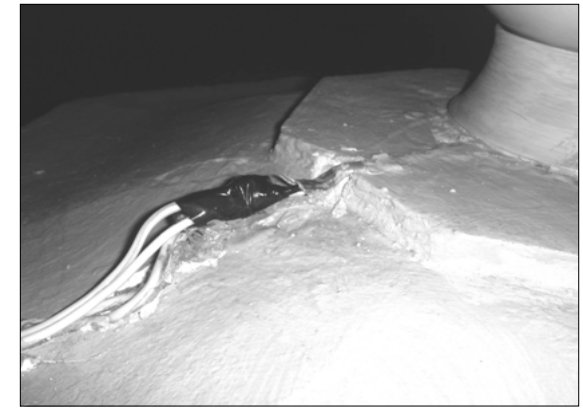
Grietas y Deterioro de material en el piso. Alteración Física.
